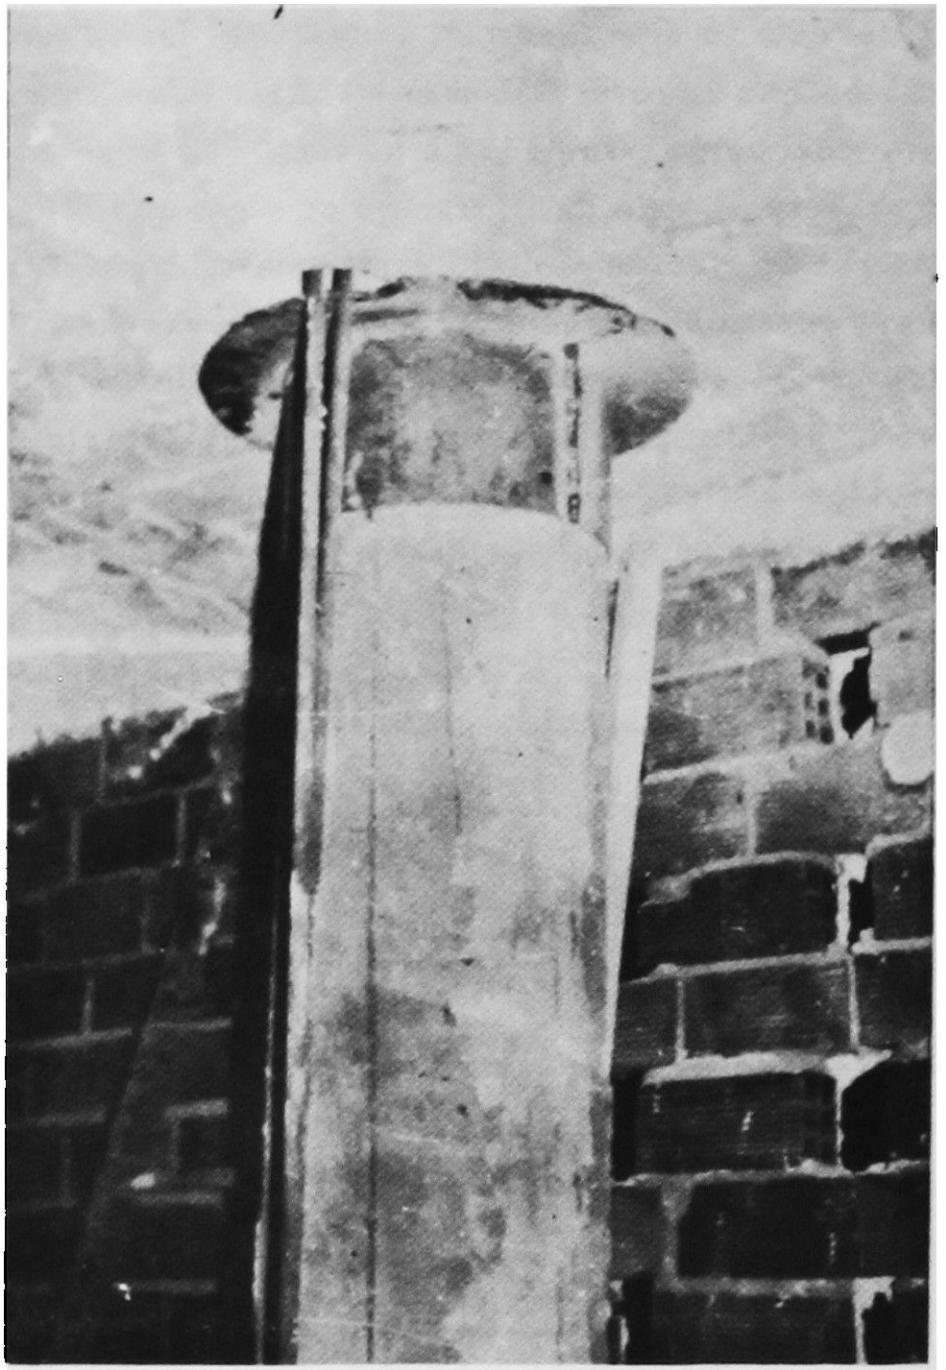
Collarín de refuerzo de la parte superior de un pilar, unido al hormigón con resinas epoxi.
